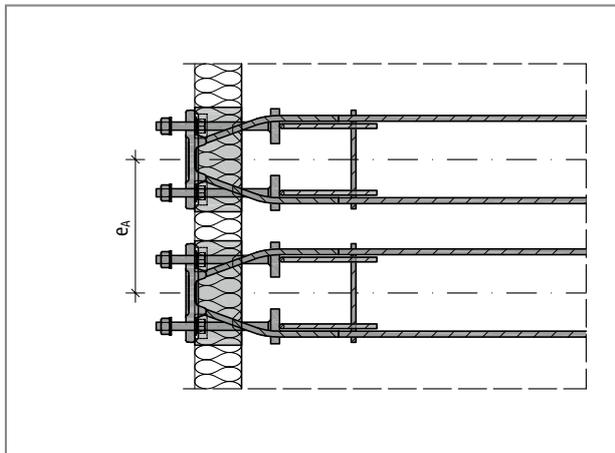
Schöck Isokorb® T Typ SQ: Achsabstand
